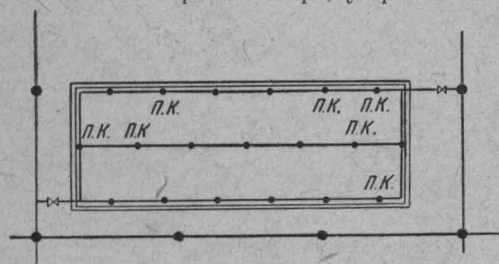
Схема присоединения внутреннего противопожарного водопровода к наружной сети.
